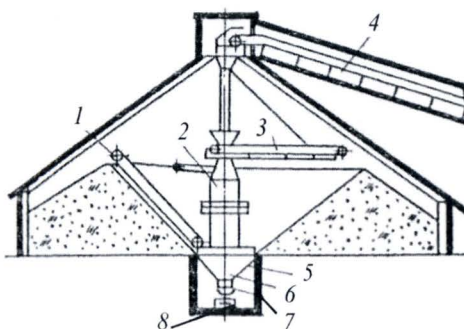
Шатровий склад сипучих вантажів круглої форми: 1 – крацер-кран; 2 – центральна колона; 3 – радіально-штабелювальний конвеєр; 4 – конвеєр подачі сипучого вантажу на склад; 5 – підштабельна галерея; 6 – перевантажувальний бункер; 7 – живильник; 8 – стрічковий конвеєр для видачі вантажу зі складу
